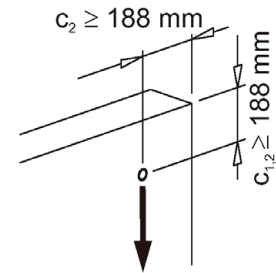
Einbausituation Wandfläche - Querbeanspruchung ohne Betonkantenbruch, ohne Rückhängbewehrung
